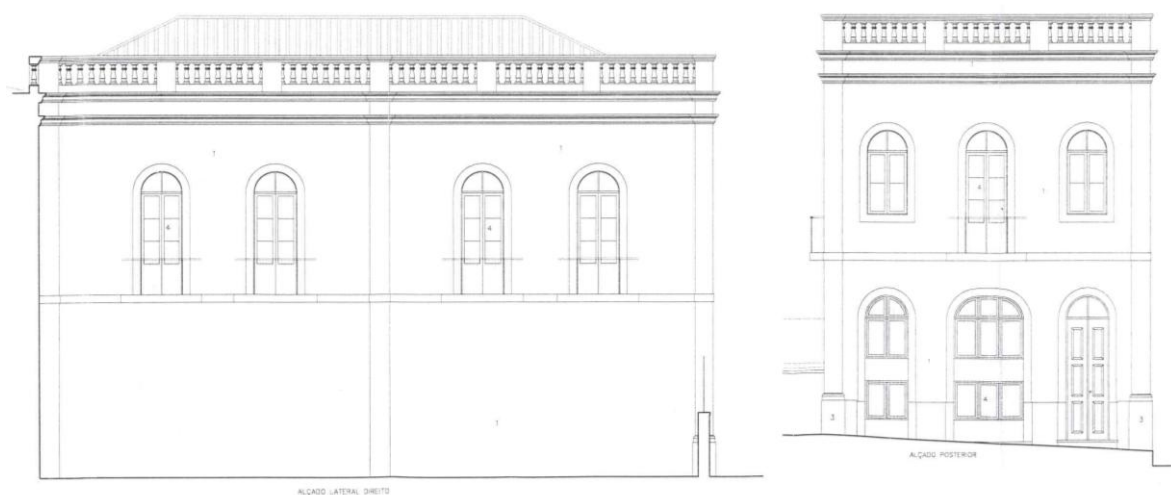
Alçado nascente e norte da ala poente da Casa do Paço
